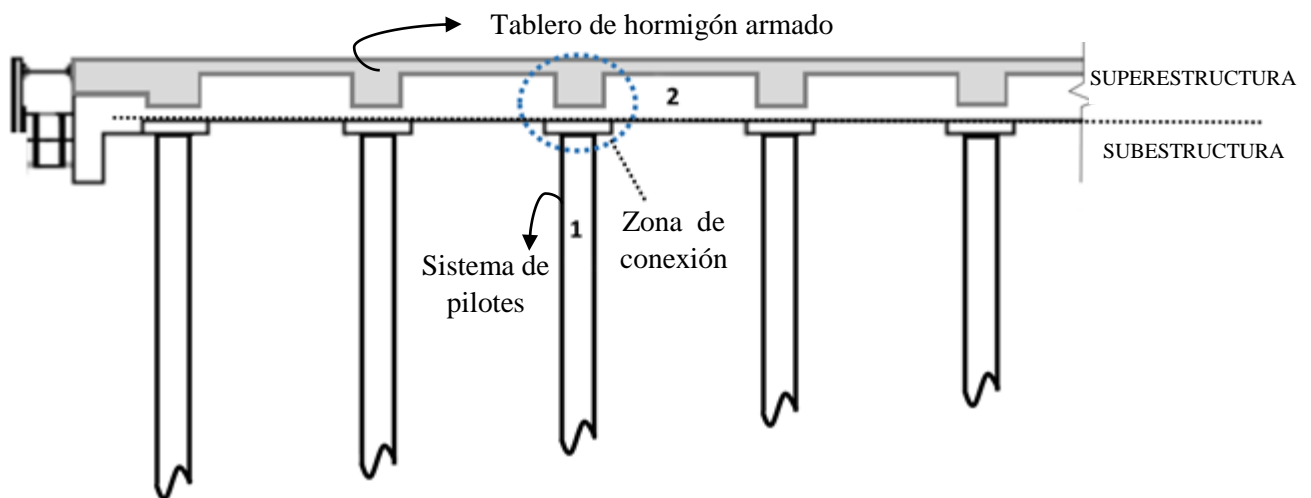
Zona de conexión entre superestructura y subestructura de muelle transparente típico.
